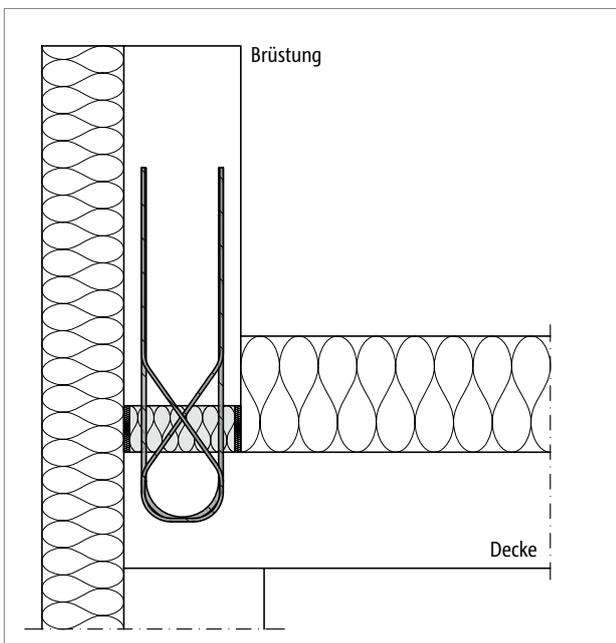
Schöck Isokorb® T Typ AP vertikale Anordnung: Anschluss einer aufgesetzten Brüstung
